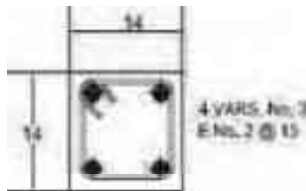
ARMADO DE CADENAS Y CASTILLOS
